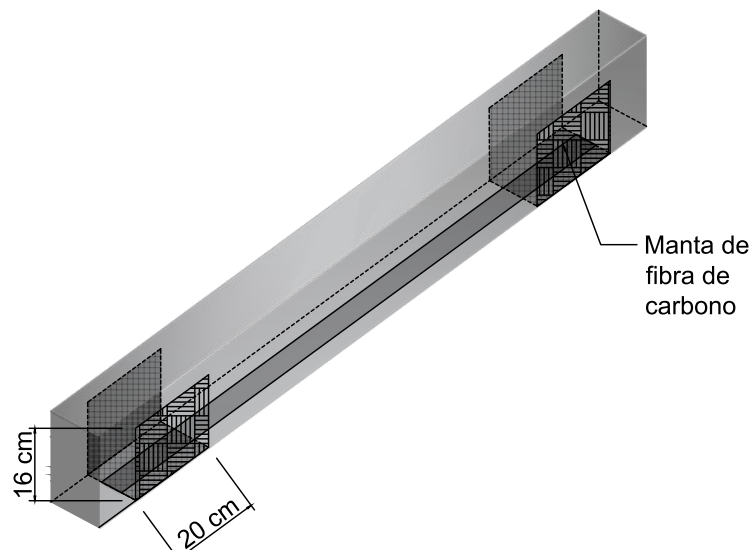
Vigas reforçadas com laminado simplesmente aderido
